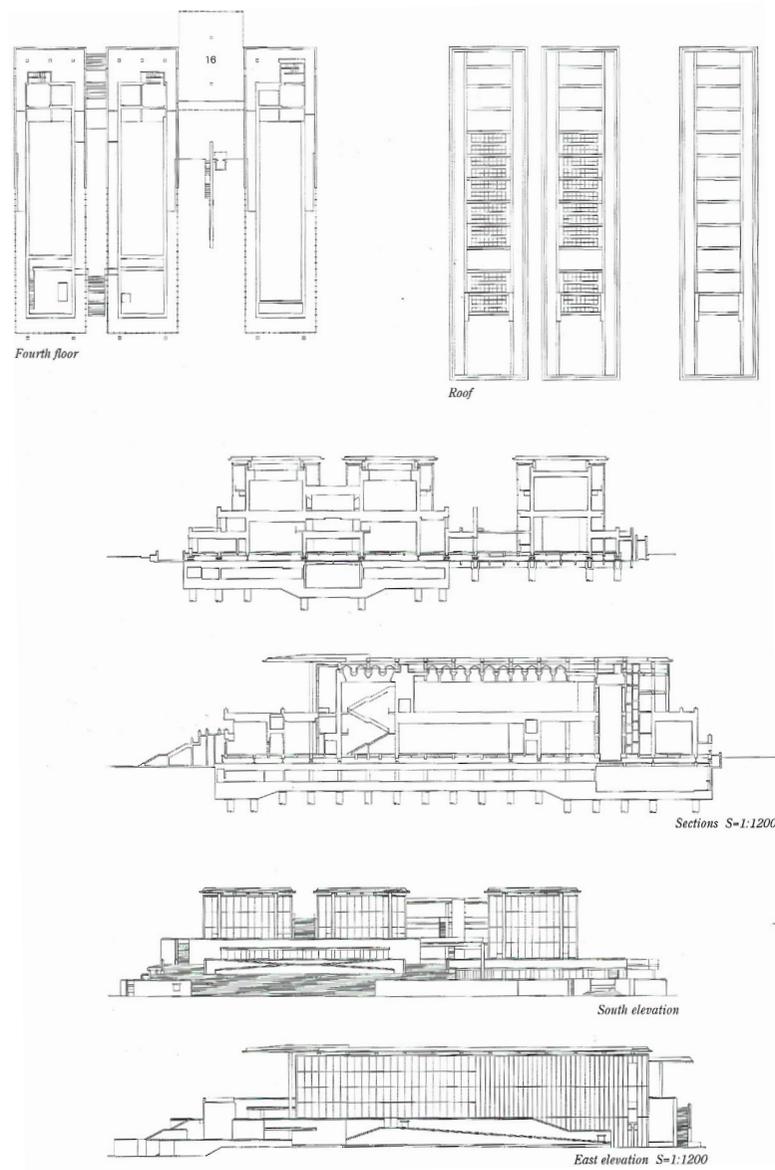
Plantas tercera y cubiertas (arriba), secciones (medio) y alzados (bajo).
